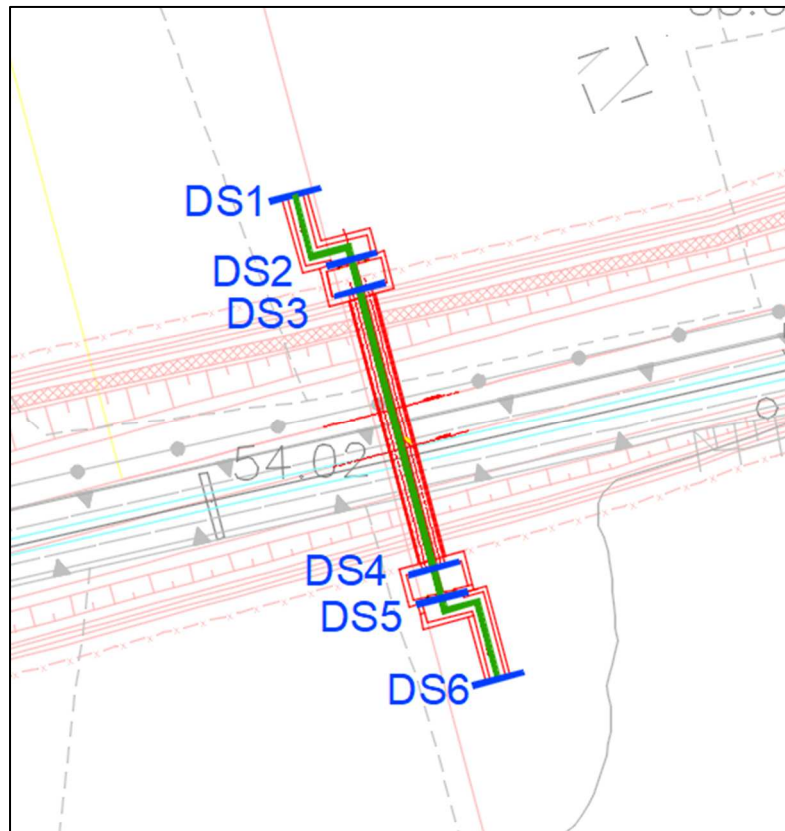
Sifone pk.27+050 – Progetto – RAS - Ubicazione sezioni
